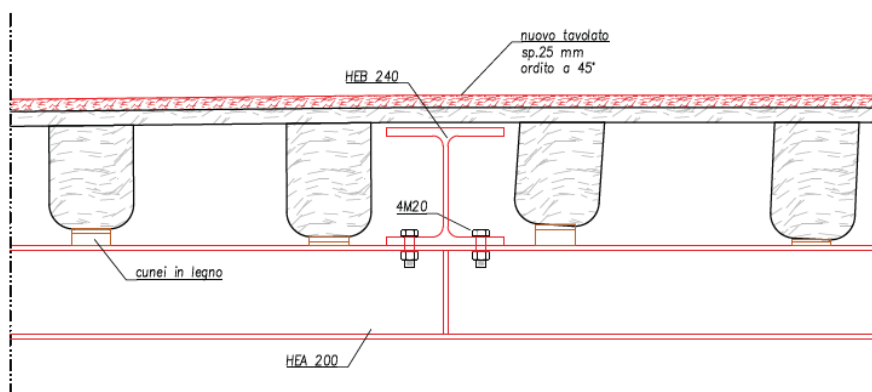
Dettaglio di collegamento delle travi in acciaio per il consolidamento del solaio in legno - Piano Primo
